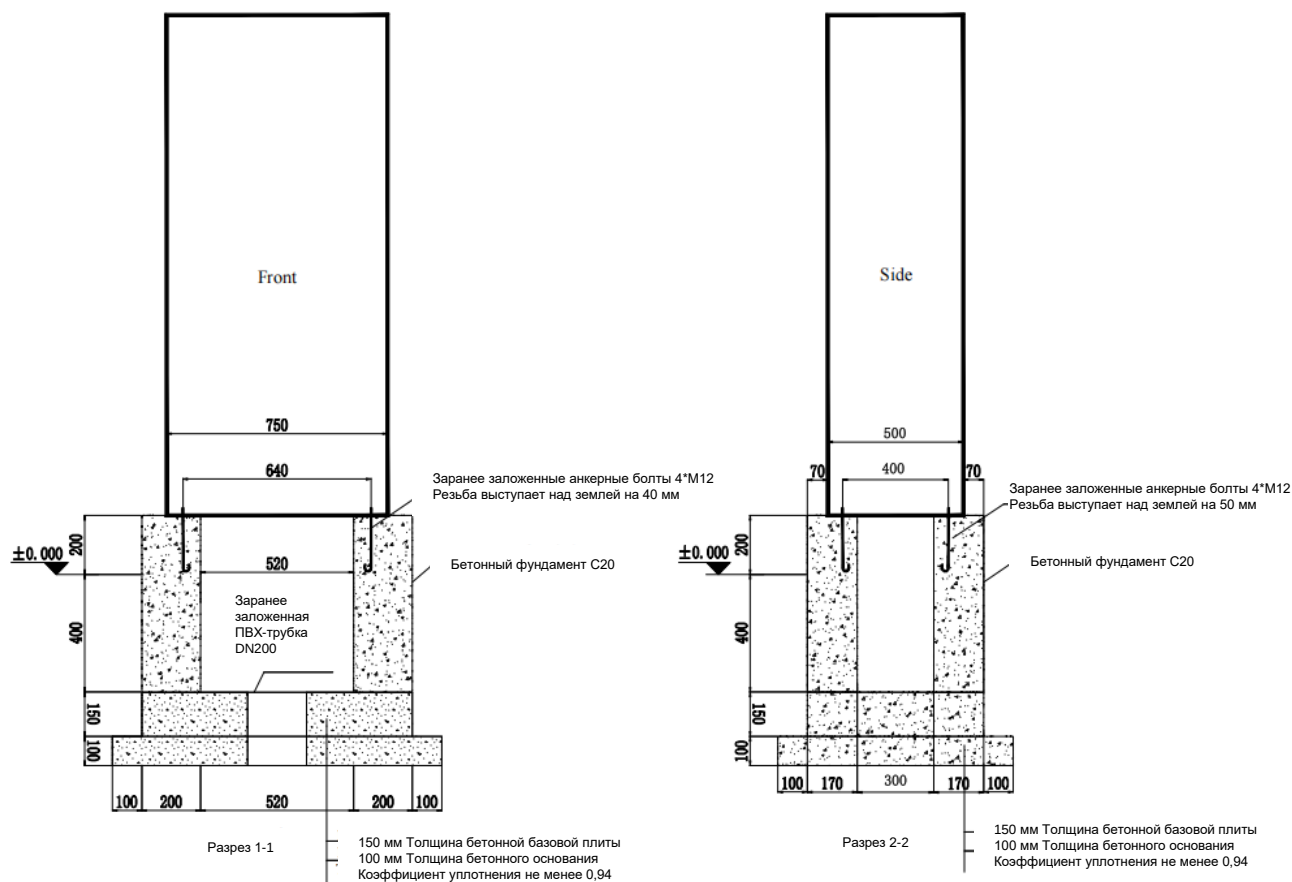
Схема фундамента YLNXD(180/200/240)К
